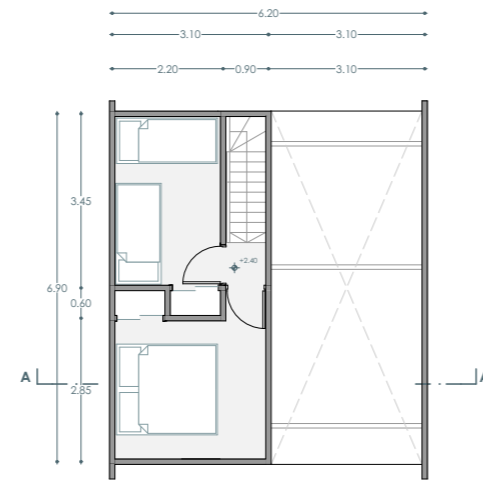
Planta alta Villa Verde. Fuente: Autores, 2023
